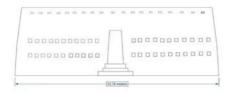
Reconstrucción hipotética de la fachada del edificio B de la Kancha Inca
